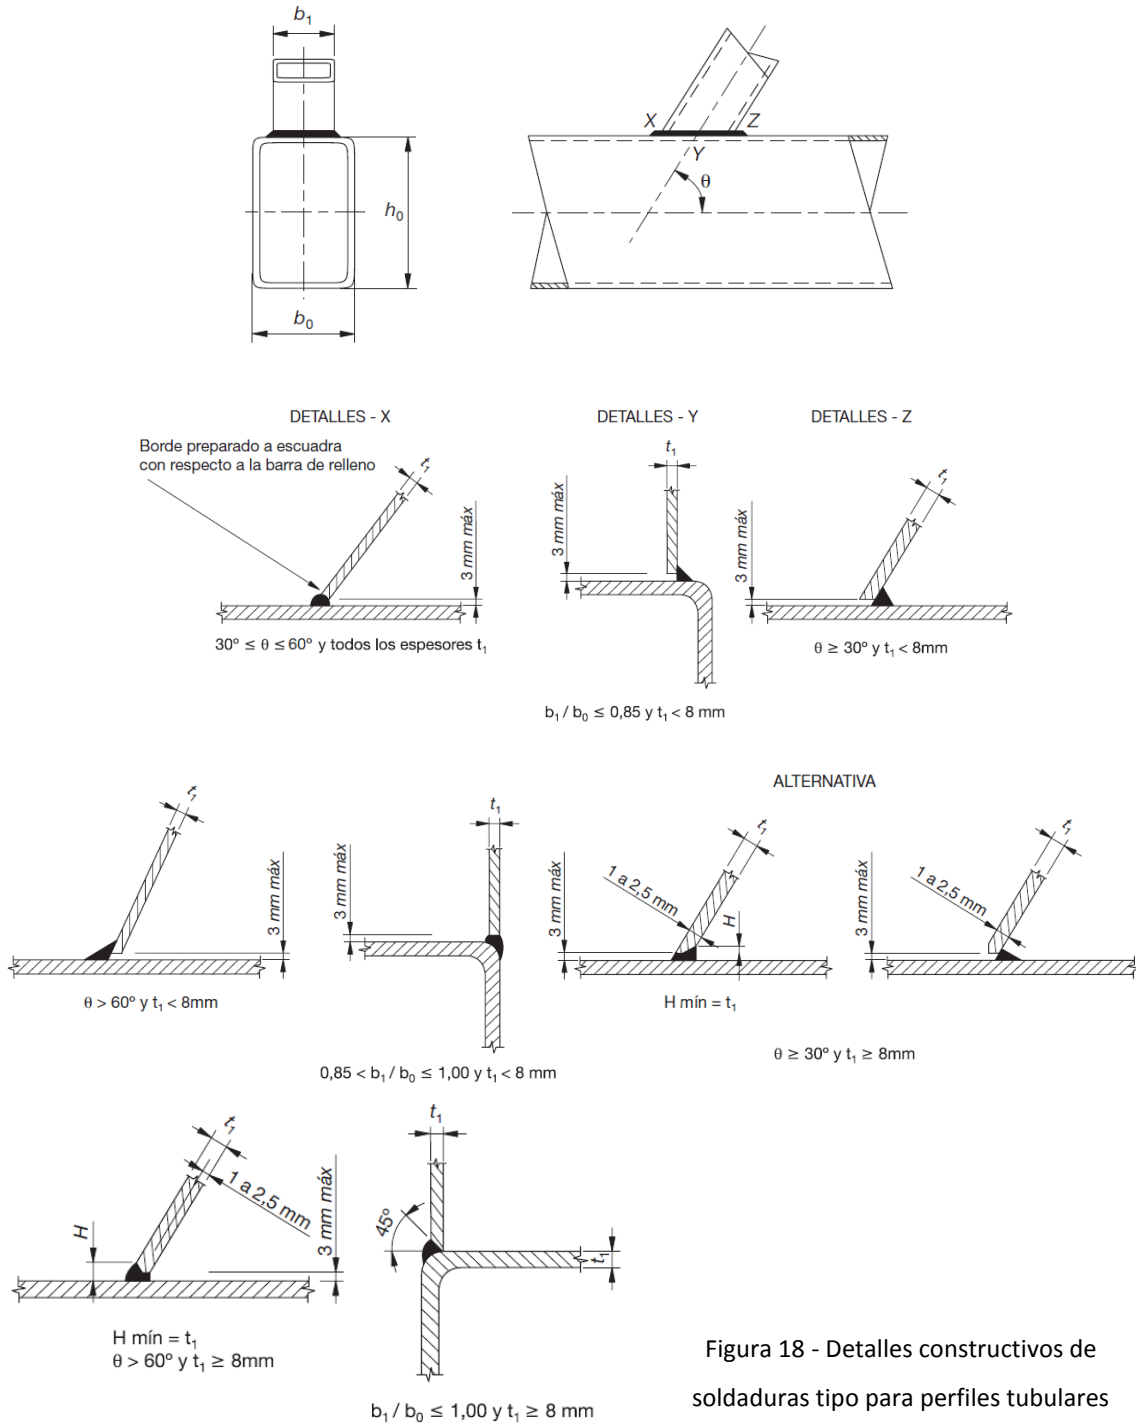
Detalles constructivos de soldaduras tipo para perfiles tubulares rectangulares. Fuente: [EAE-11](#)
